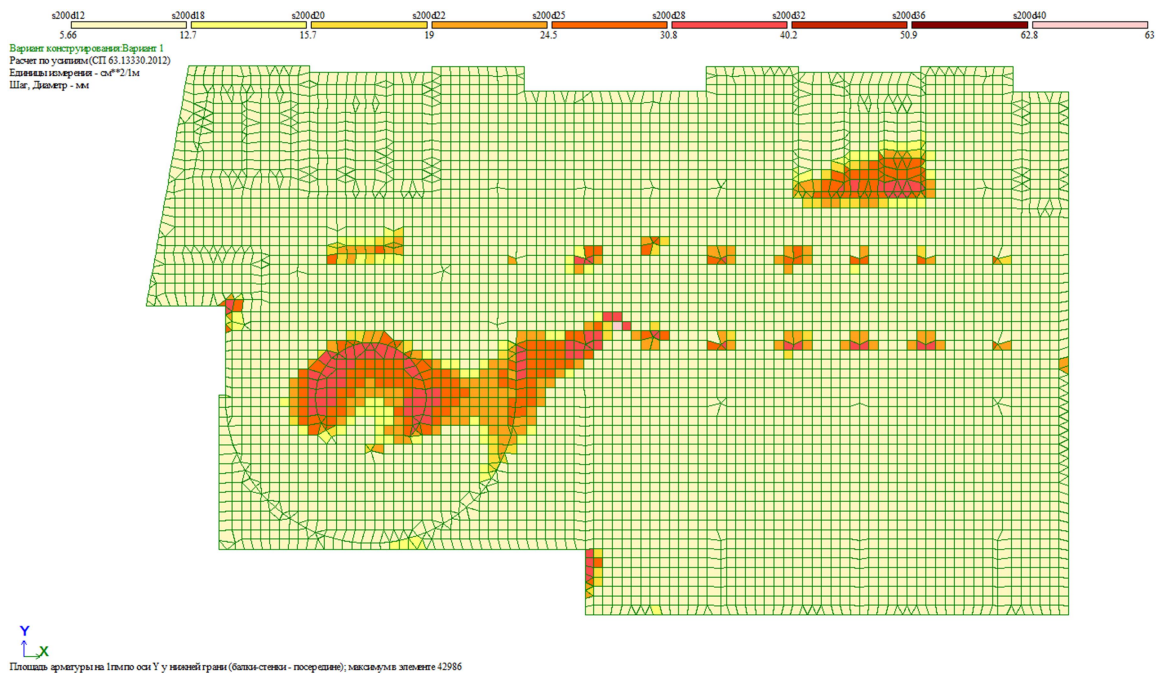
Нижнее армирование по Y. Расчет с учетом этапов возведения здания
